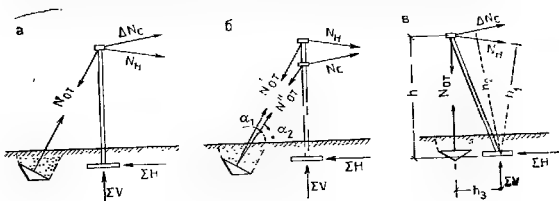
Расчетные схемы оттяжек в двухъярусных покрытиях с параллельными вантами: а — при одном бортовом элементе; б — то же, при двух; в — при наклонной стойке
